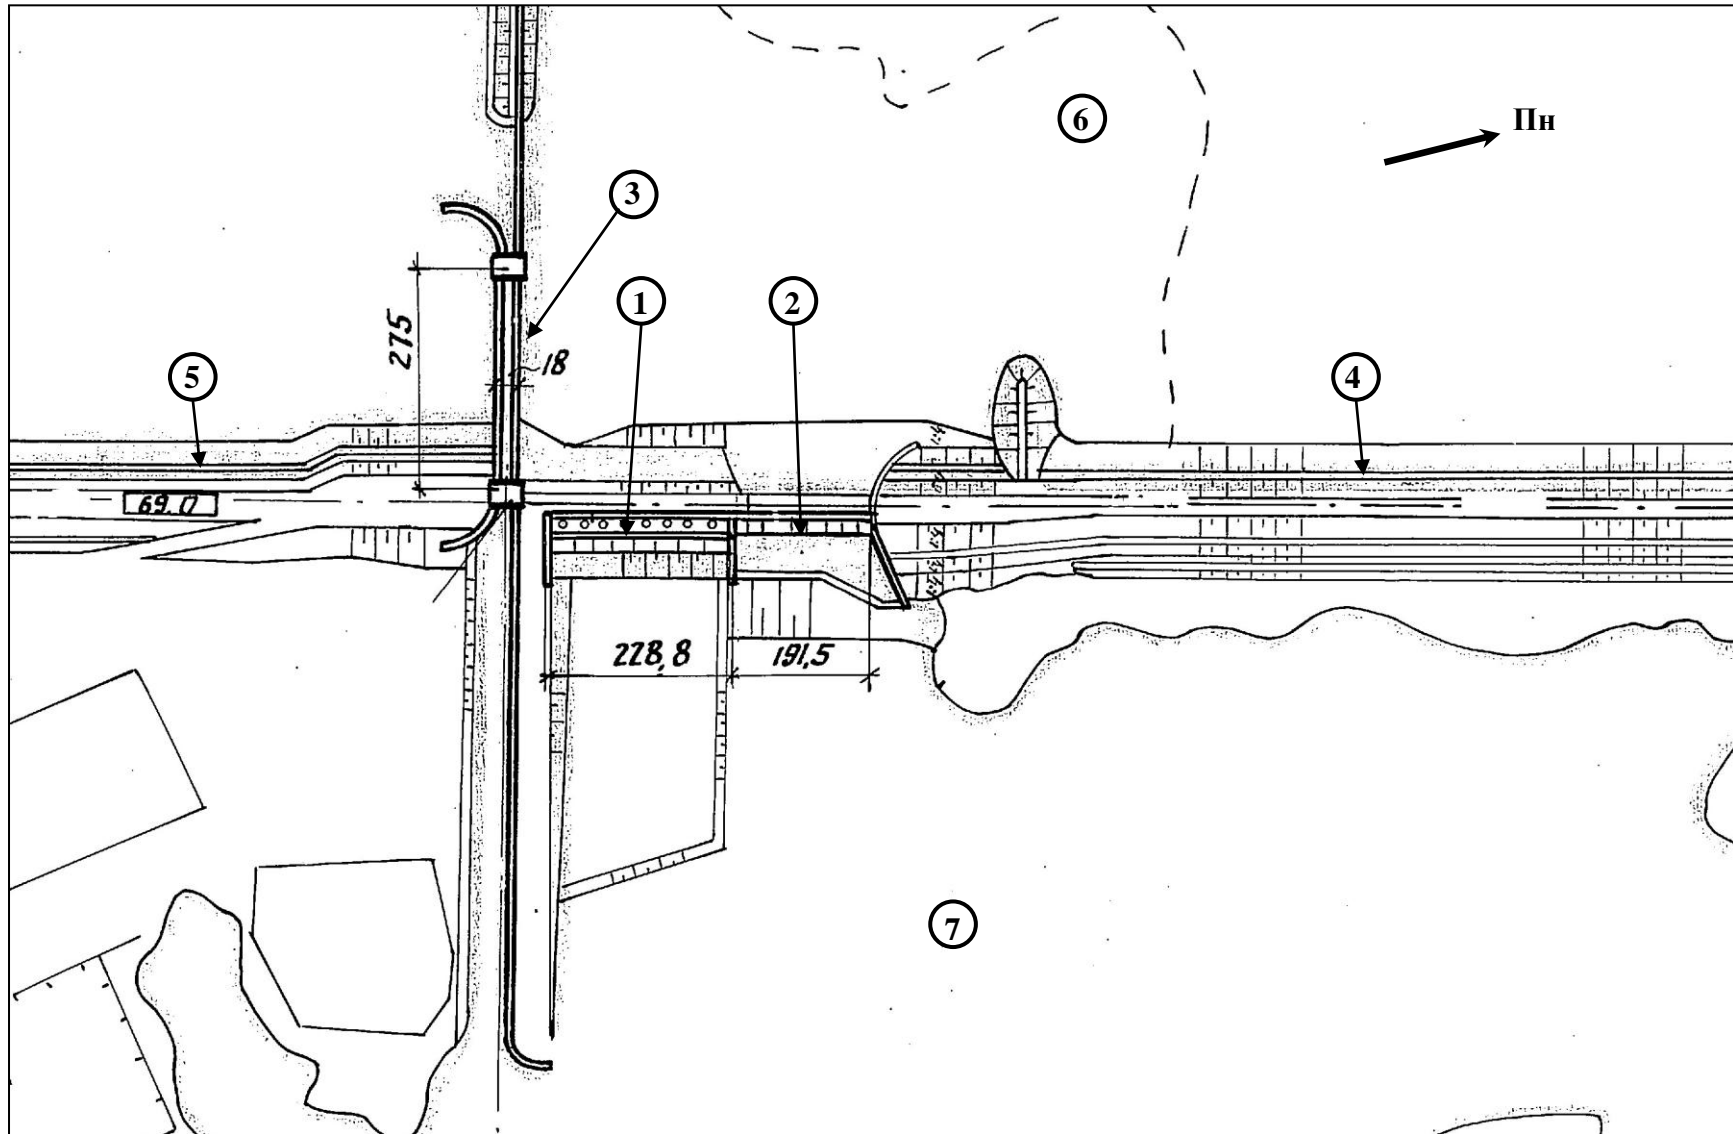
Фрагмент плану Середньодніпровського гідровузла: 1 – будівля гідроелектростанції; 2 – бетонна водозливна гребля; 3 – шлюз; 4 – руслова гребля; 5 – правобережна гребля; 6 – Кам'янське водосховище; 7 – нижній б'єф (розміри в м.)
